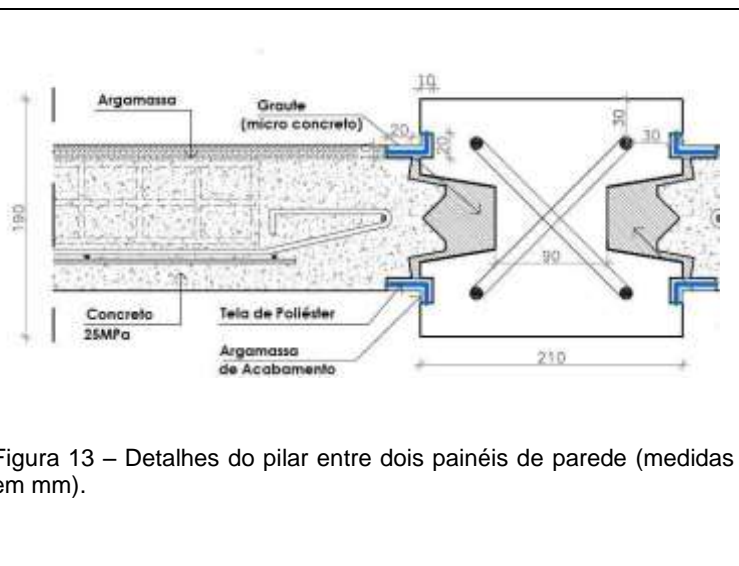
Detalhes do pilar entre dois painéis de parede (medidas em mm).
